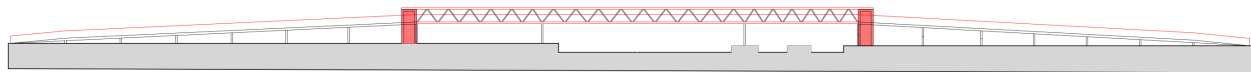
Étape 6 : Montage puis bétonnage prédalles, montage garde-corps et toiture, finalisations
